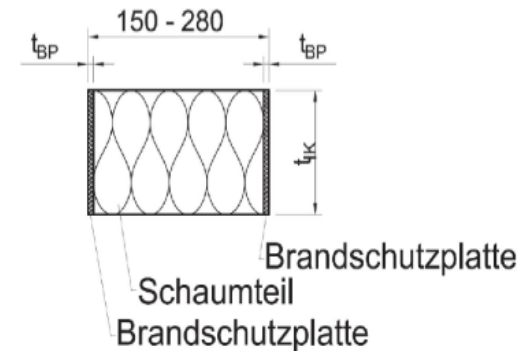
Schöck Isokorb® CXT Typ A Part Z für Attiken und Brüstungen
